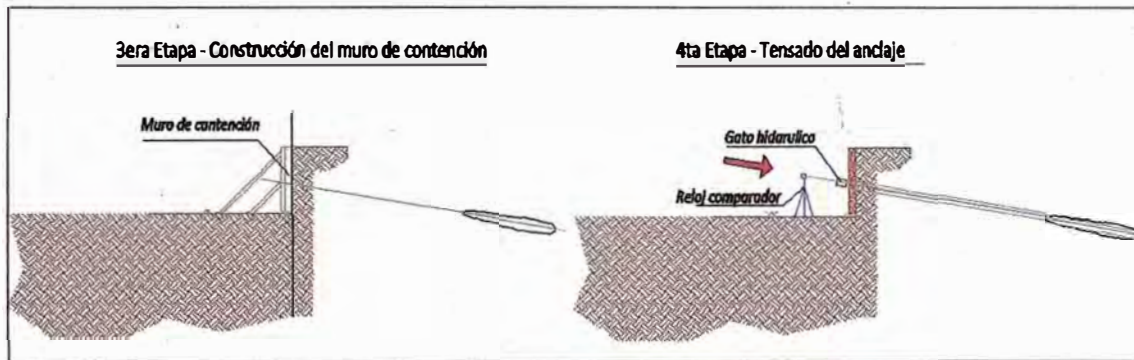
Secuencia de construcción del muro y tensado del anclaje
